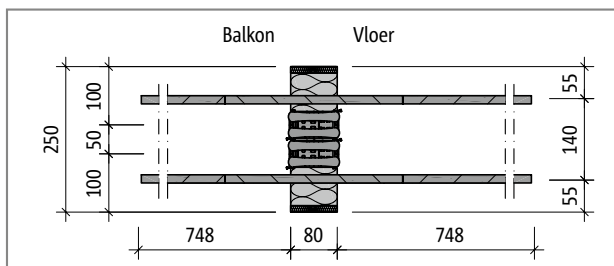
Schöck Isokorb® T type Q-E-W5-L500: Bovenaanzicht
